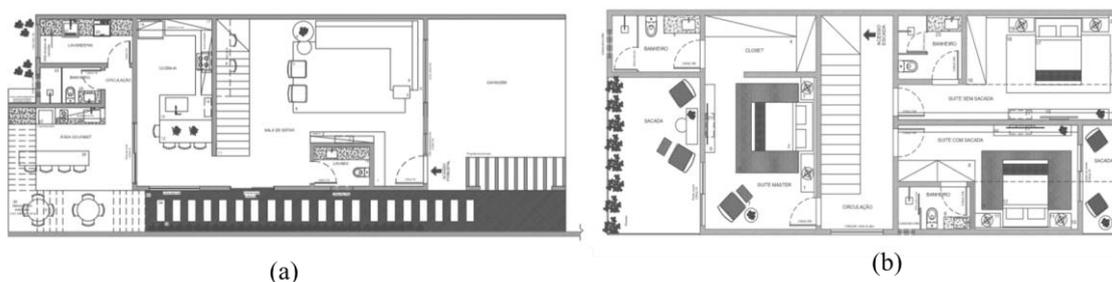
Layout dos pavimentos inferior (a) e superior (b). (FONTE: acervo da empresa).
